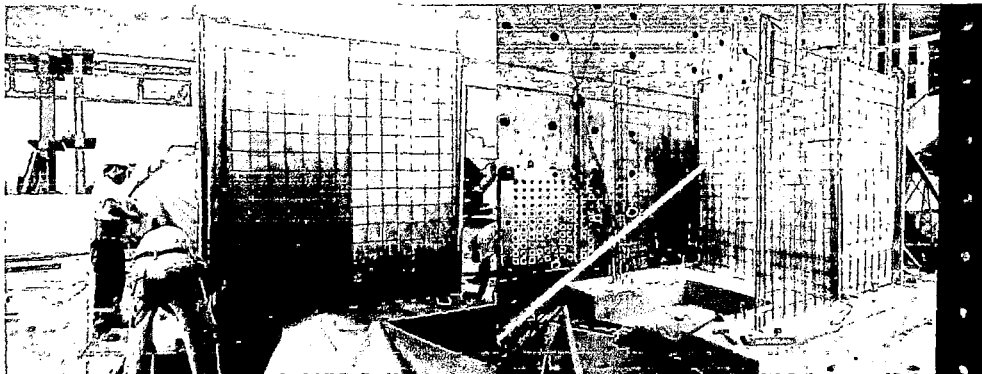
Malla de refuerzo. Izquierda: Espécimen 01. Derecha: Espécimen 04.
